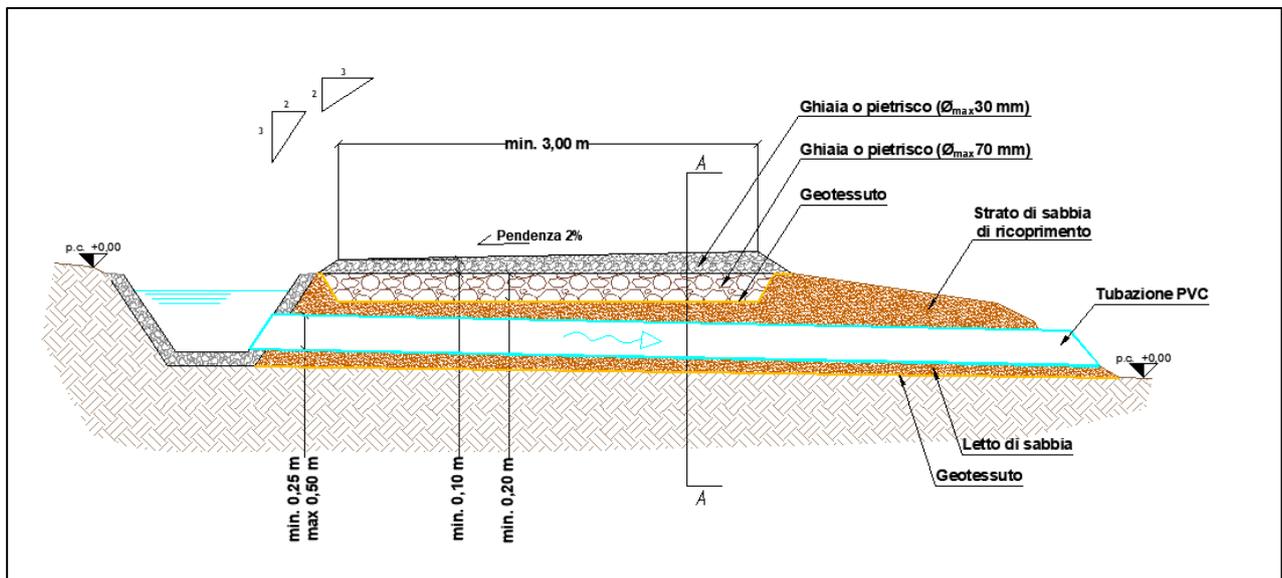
Tipologico sezione stradale viabilità interna con attraversamento tubo di drenaggio acque meteoriche
